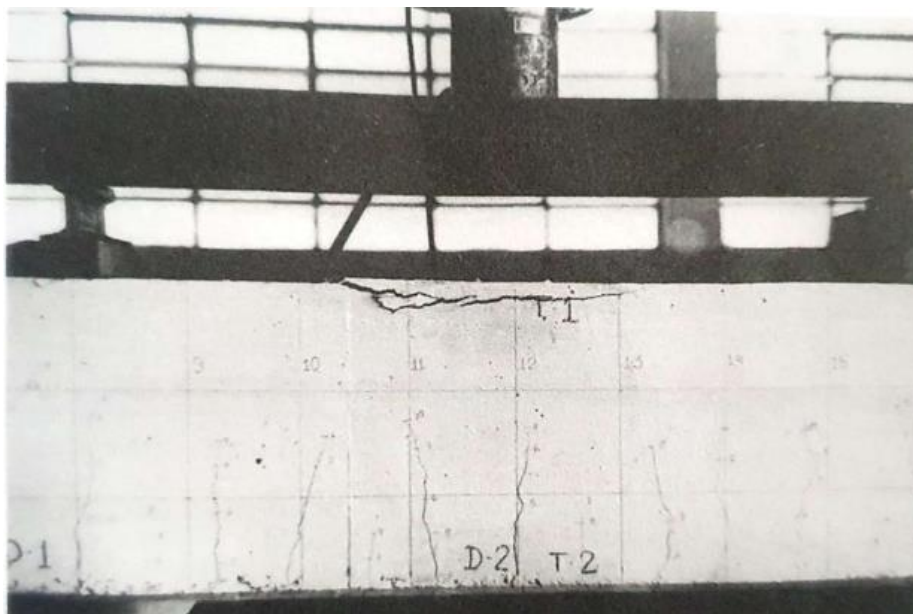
Fissura de cisalhamento em viga solicitada à flexão
